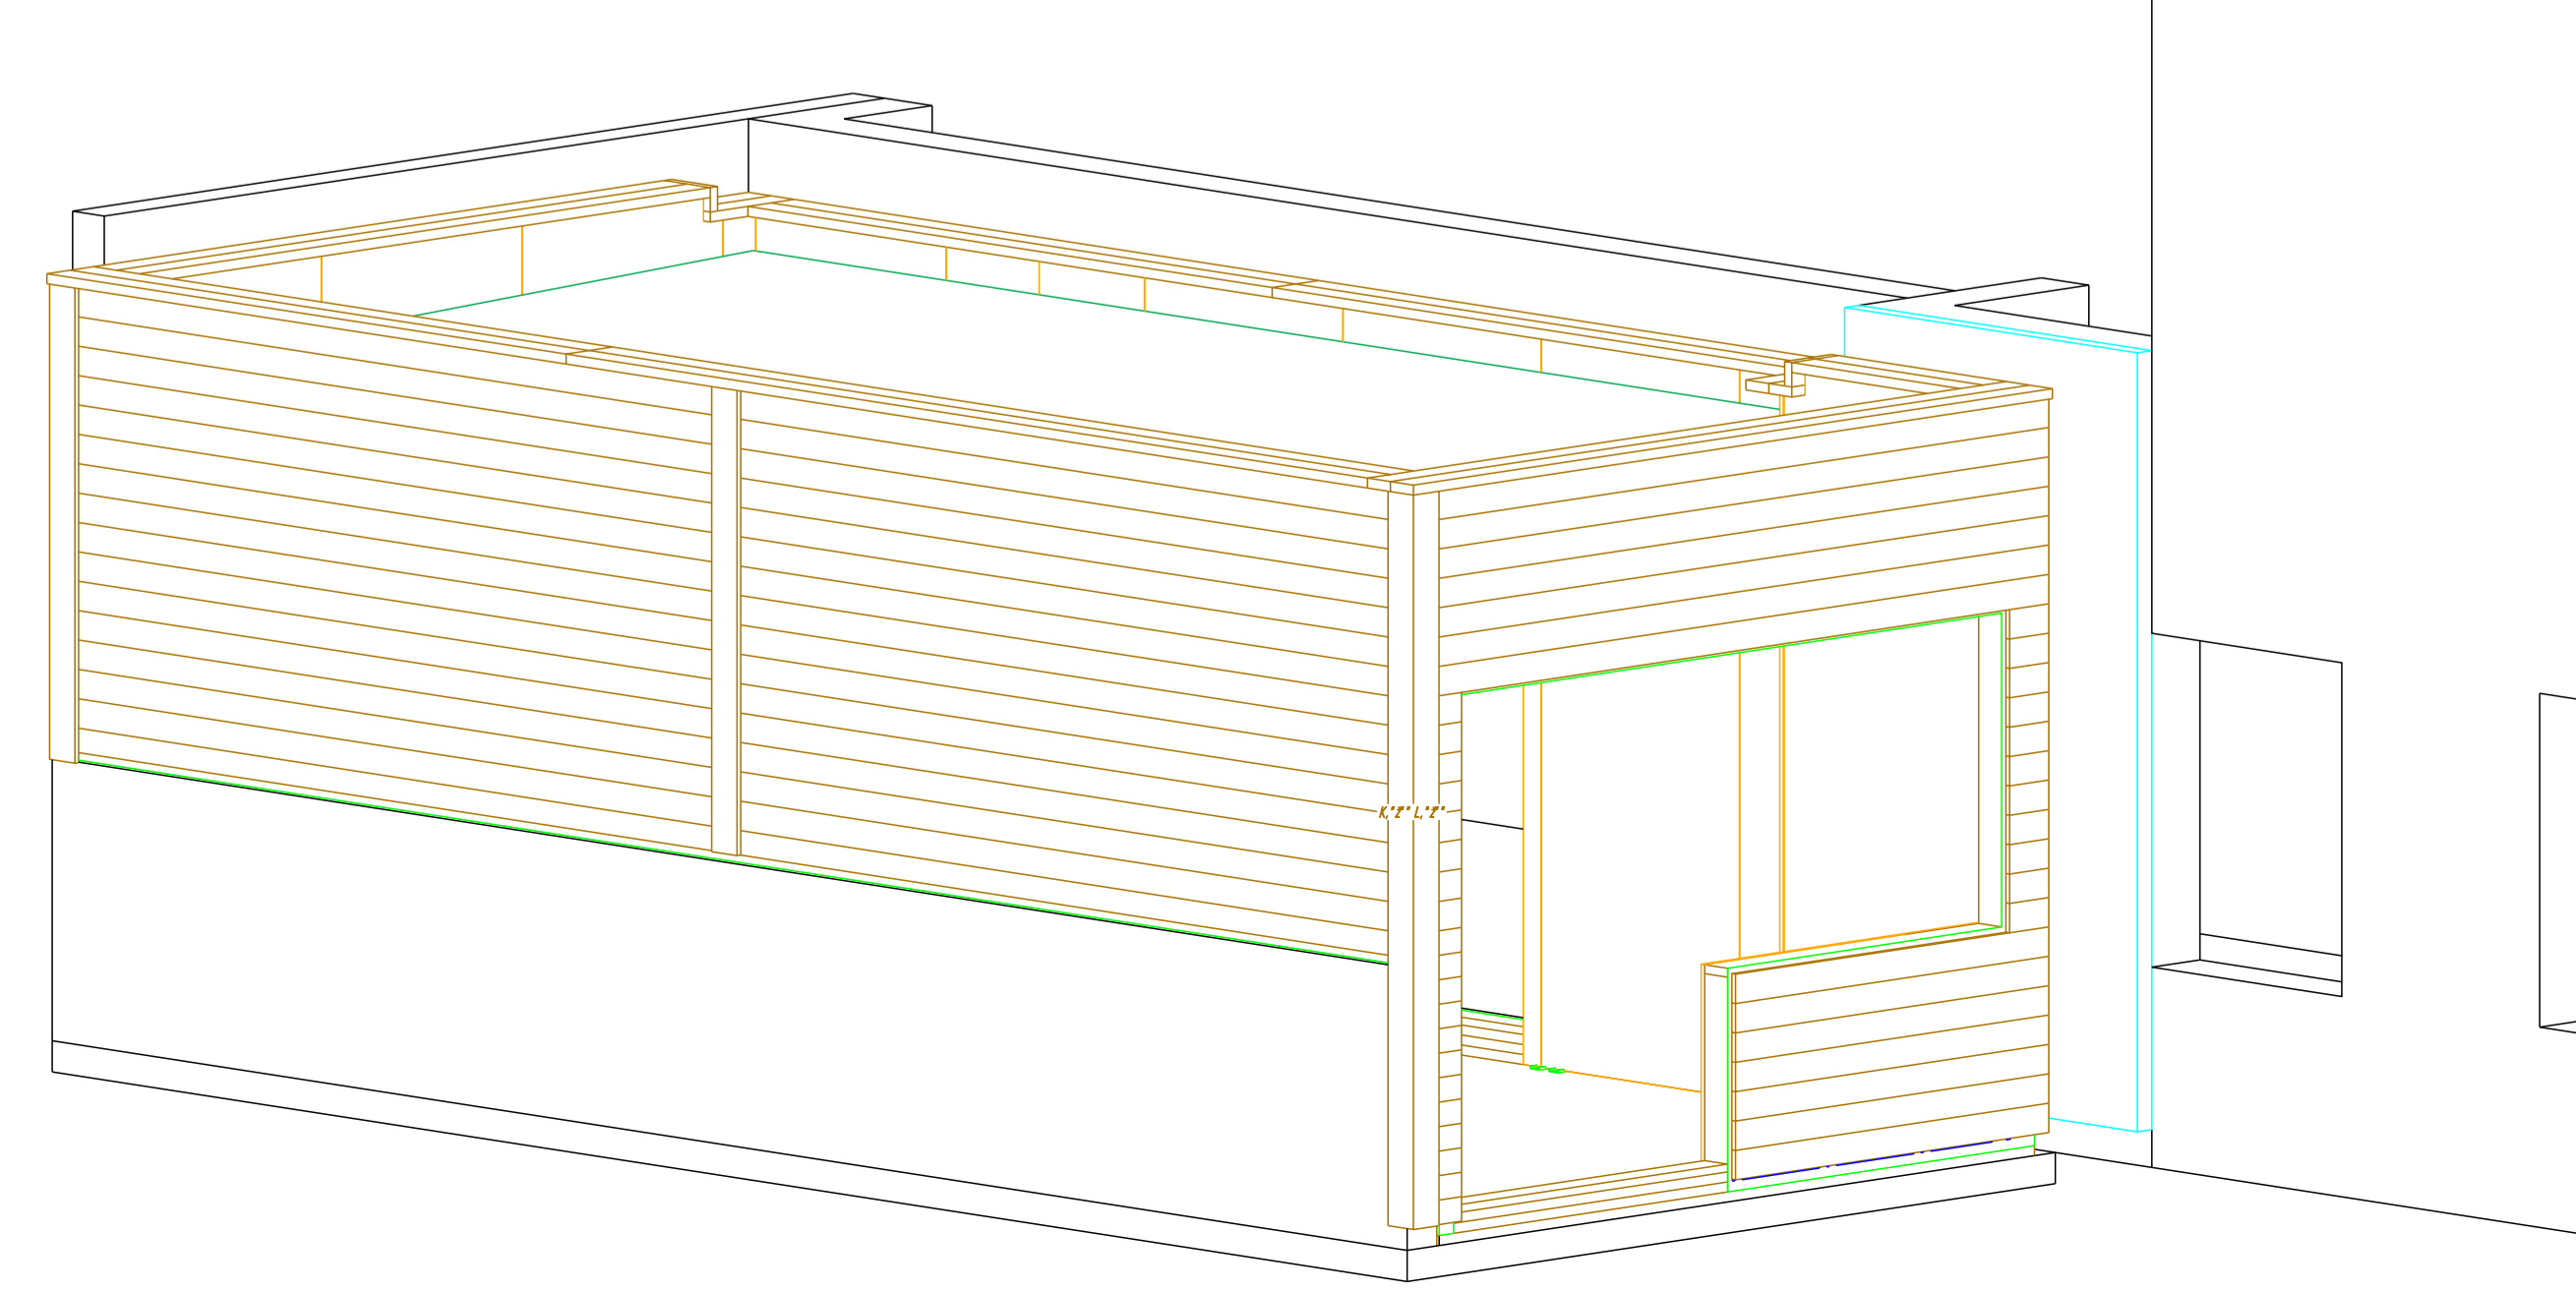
DETAIL Mise en place bande pare-vapeur dans le joint de dilatation
